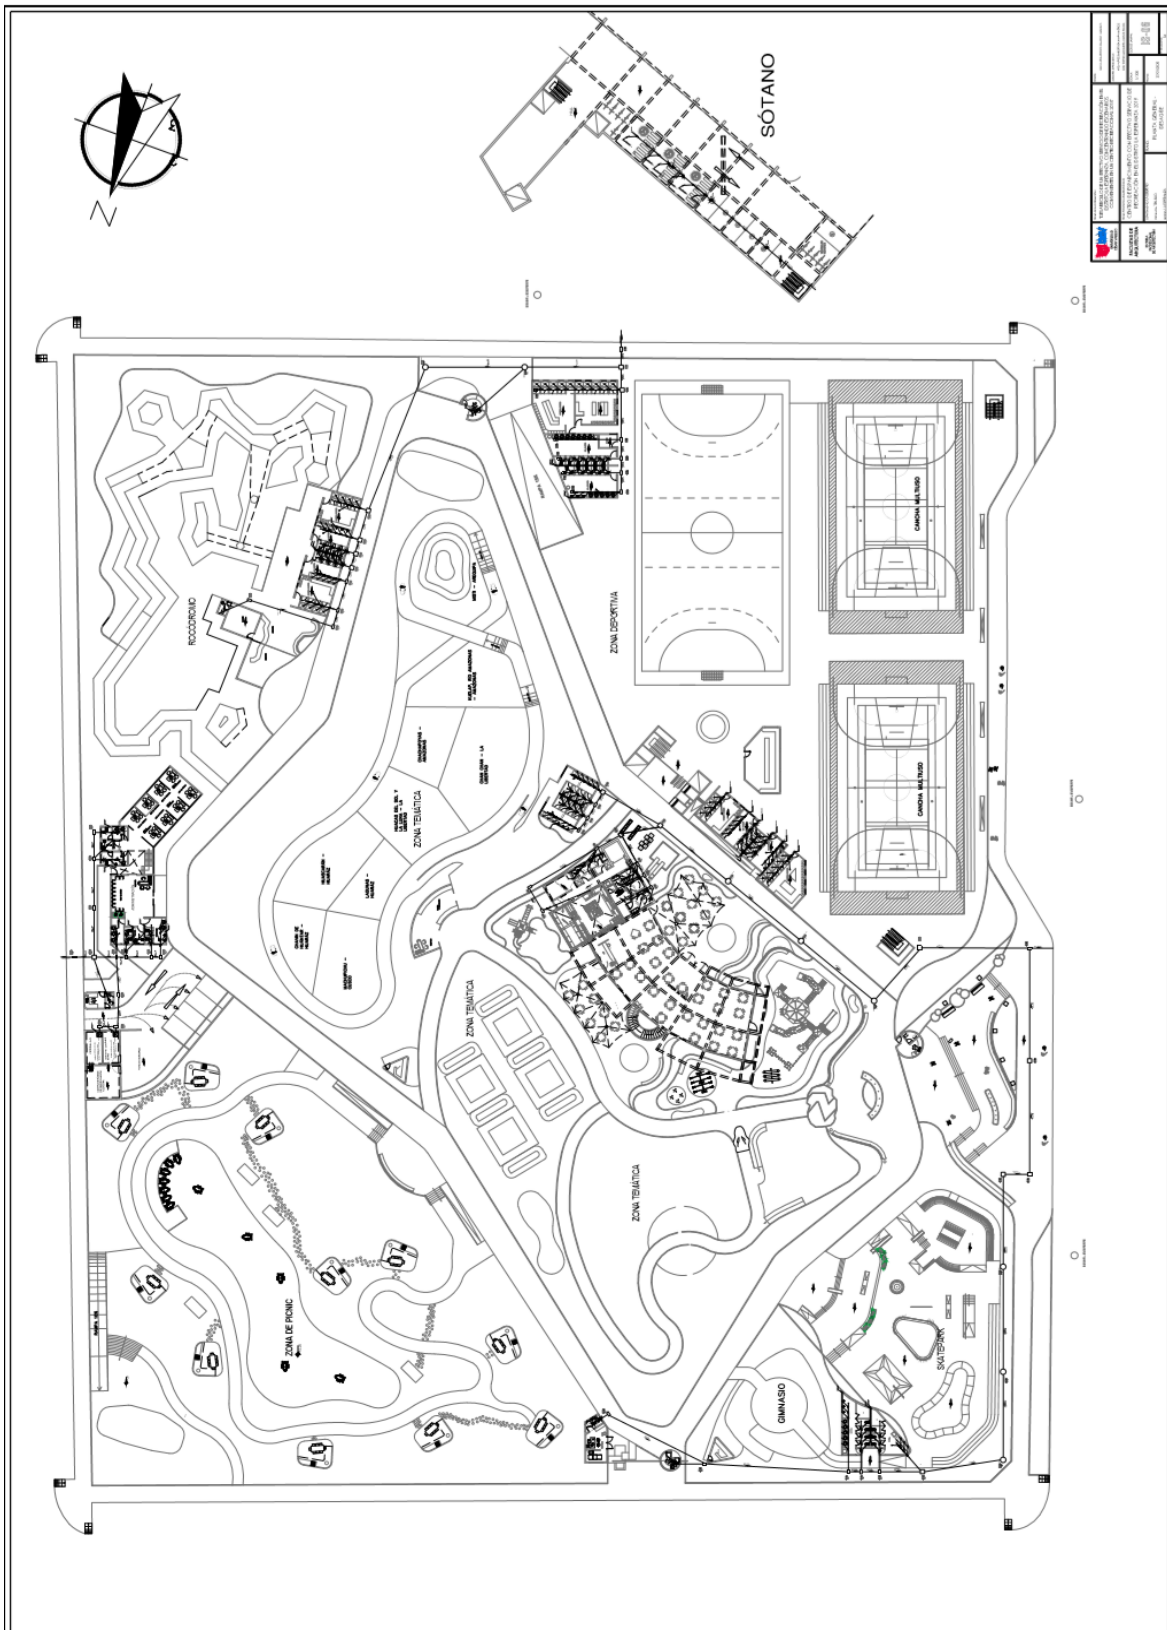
Plano de Desagüe Planta General. Elaboración propia.
